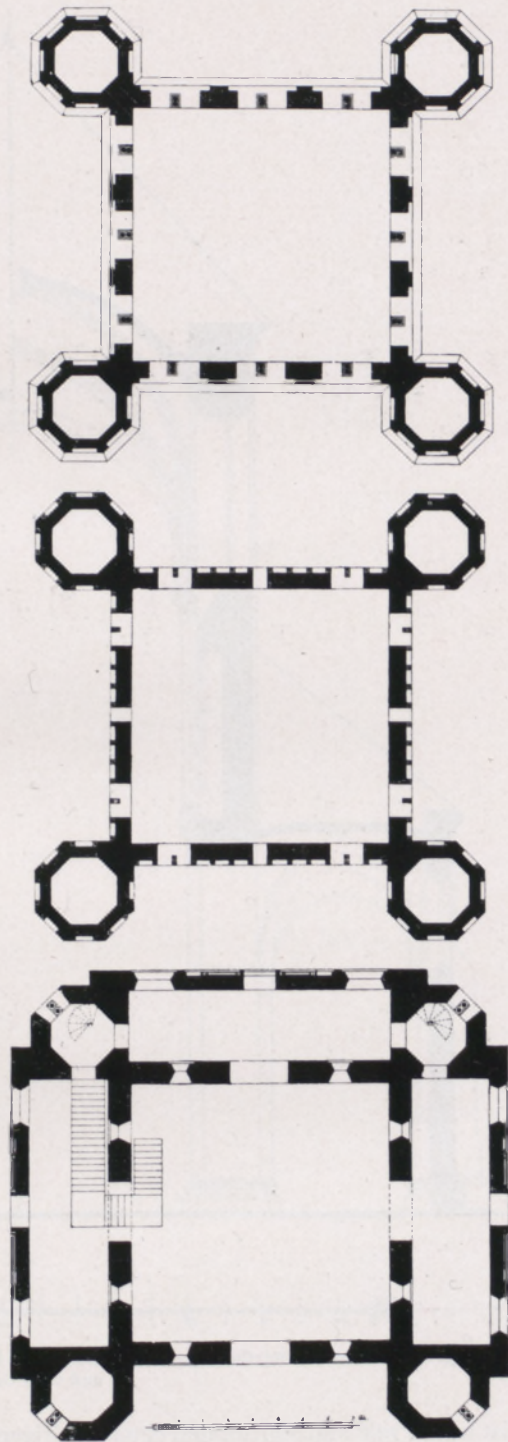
Gross St. Martin. Grundrisse des Vierungsturmes.
